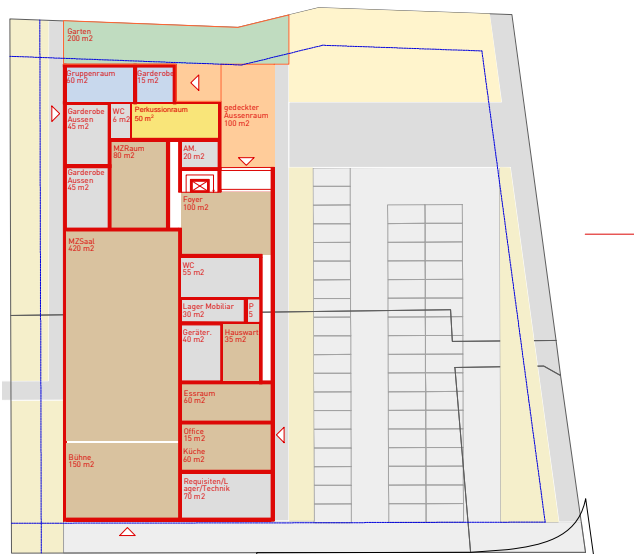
Schemaplan Mehrzweckgebäude mit Spielhüsli
